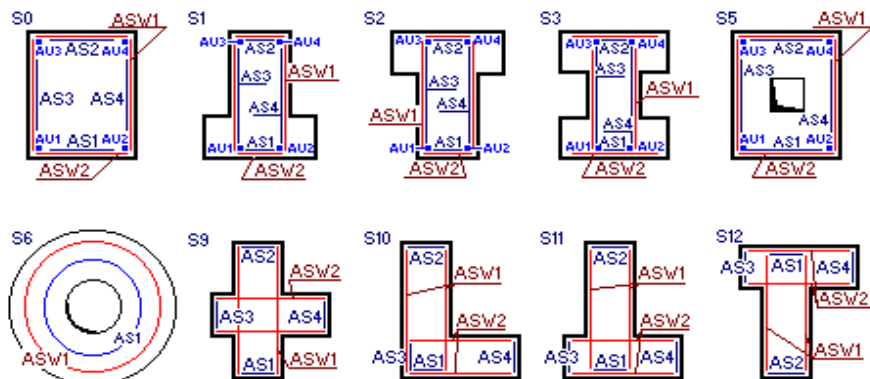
Позначення армування у перерізах ЗБК
